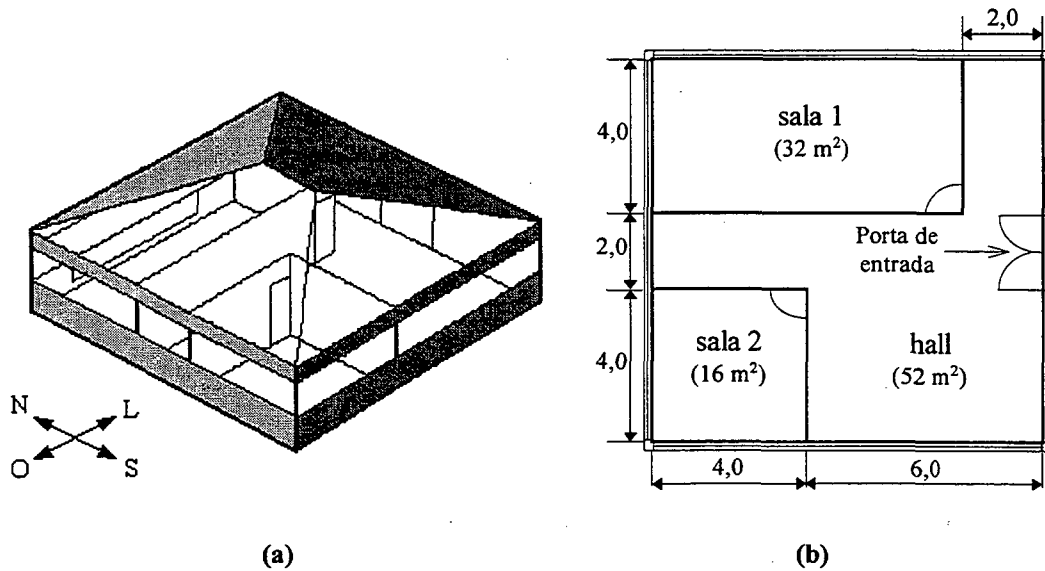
Parte simulada da edificação: (a) Fachada externa da edificação; (b) Planta baixa das zonas ocupadas.
